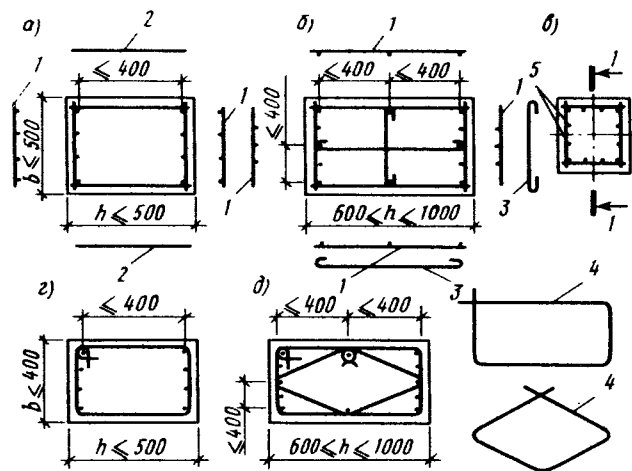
Армирование сжатых элементов с гибкой арматурой:
